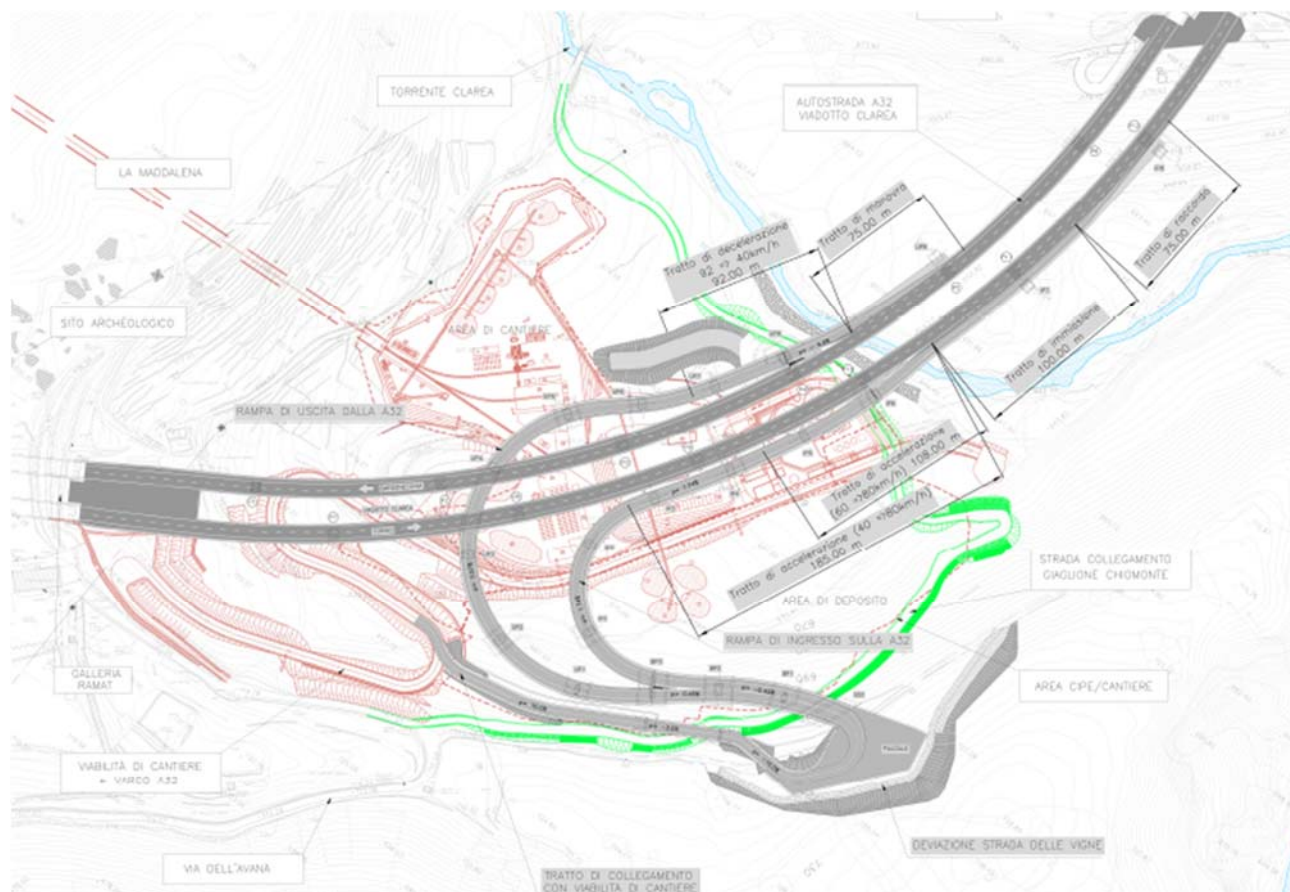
Stralcio planimetrico del progetto definitivo approvato dello svincolo della Maddalena
